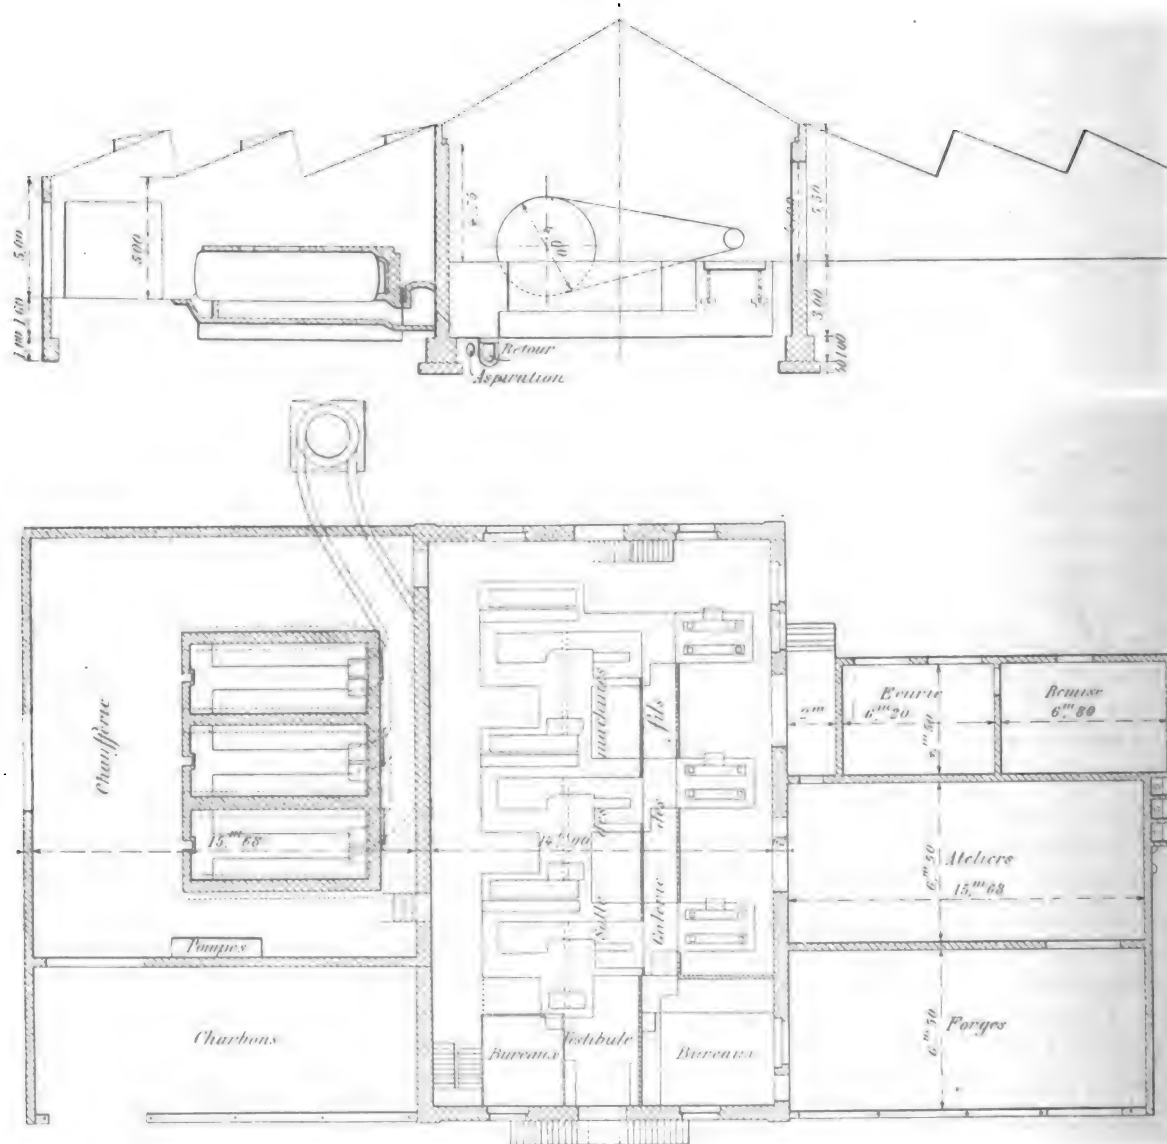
et 6. — Coupe et plan de la station génératrice.
